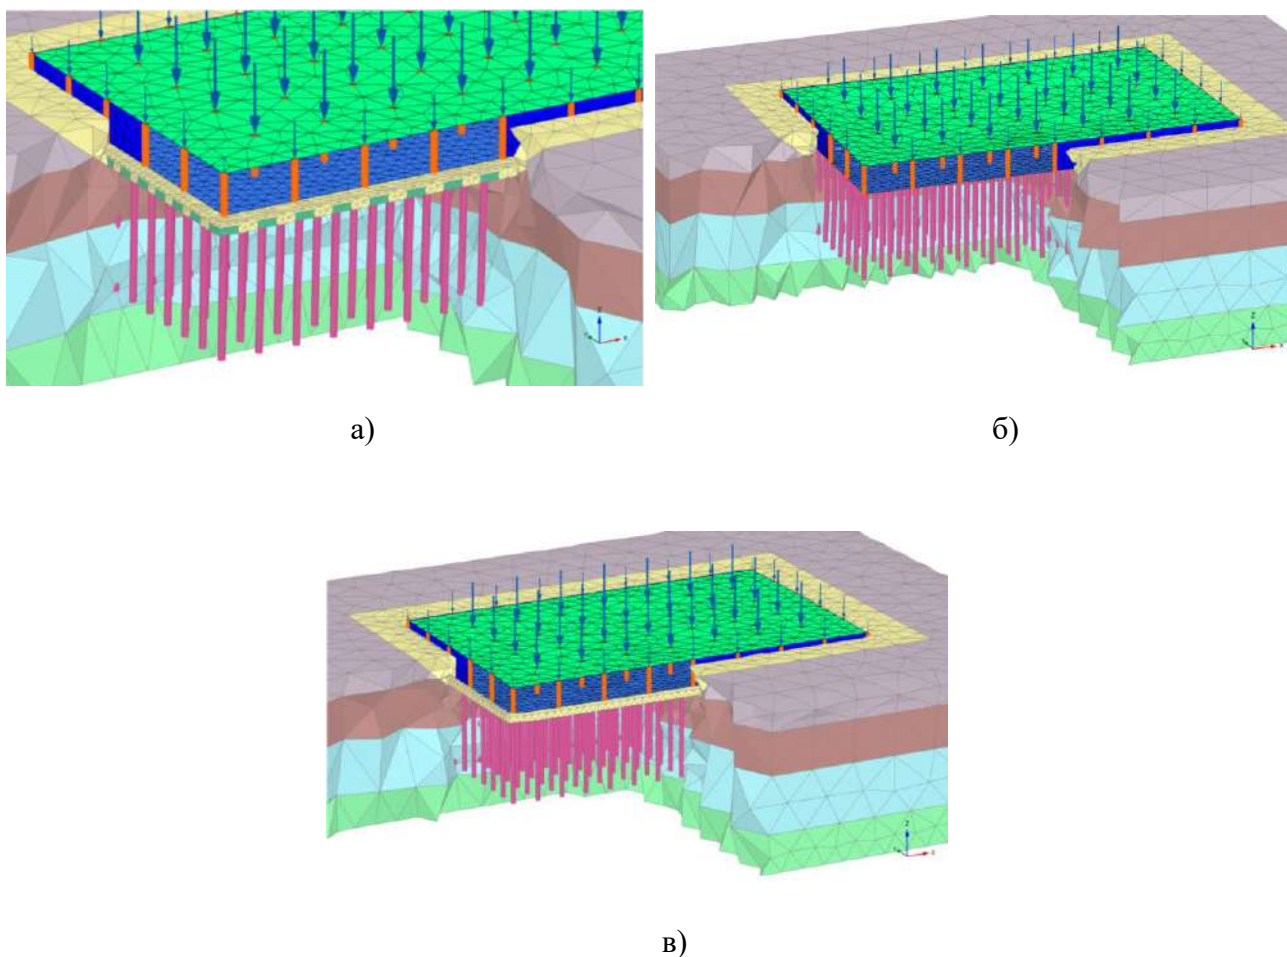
Расчётные схемы: а) свайный фундамент с заглубленными локальными ростверками; б) комбинированный свайно-плитный фундамент (КСПФ); в) армированное основание
